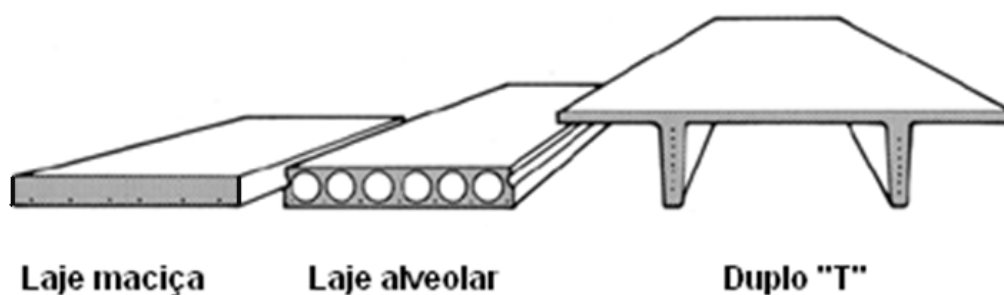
Lajes maciças, lajes duplo “T” e lajes alveolares (Paradigm)
